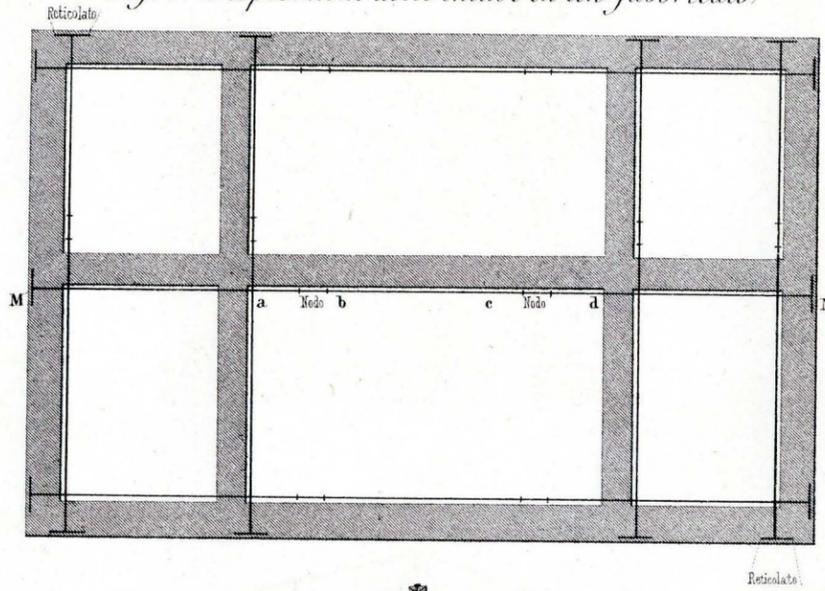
ª Pianta di una casa baraccata al piano delle travi del solaio al piano dei davanzali delle finestre
